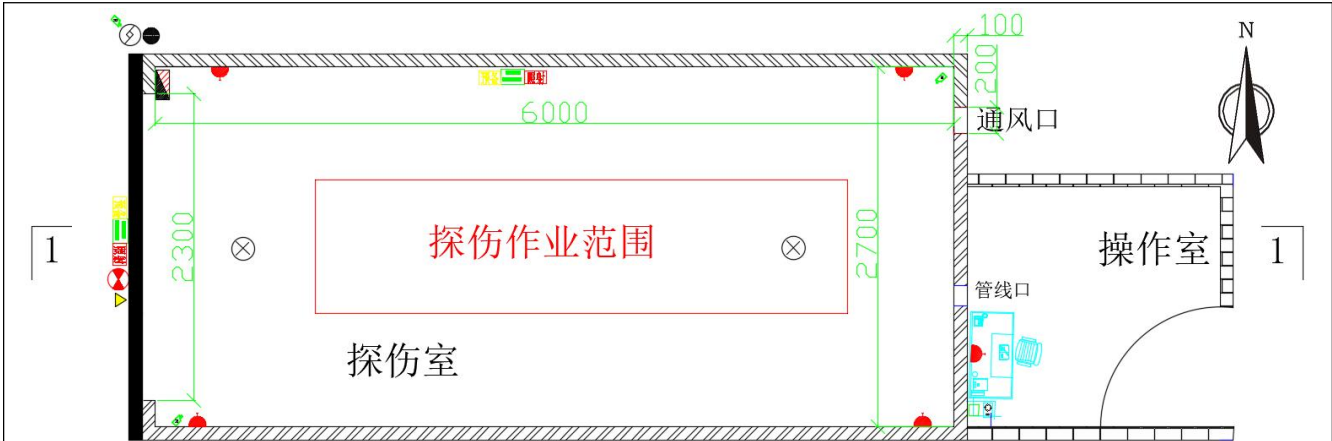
(a) X 射线探伤机在探伤室内探伤作业范围示意图（平面图，单位：mm）
